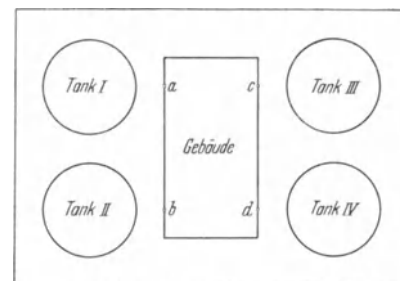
Vorschlag für eine Grundrißgestaltung des Tankparks.
